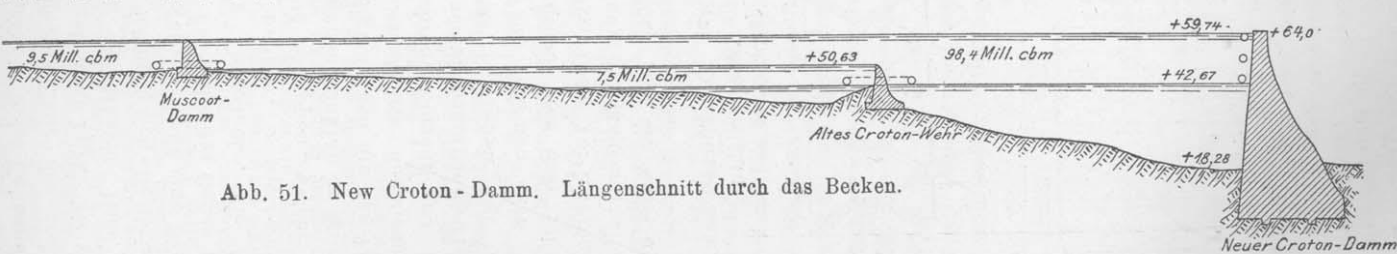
New Croton - Damm. Längenschnitt durch das Becken.
